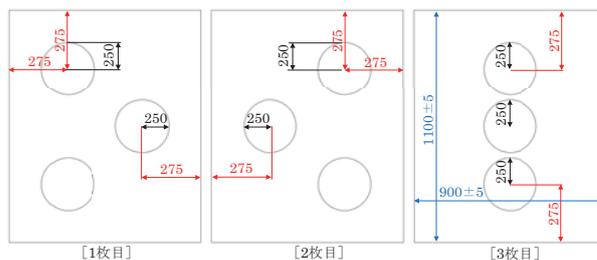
鋼球加撃体の加撃位置 (寸法単位: mm)
